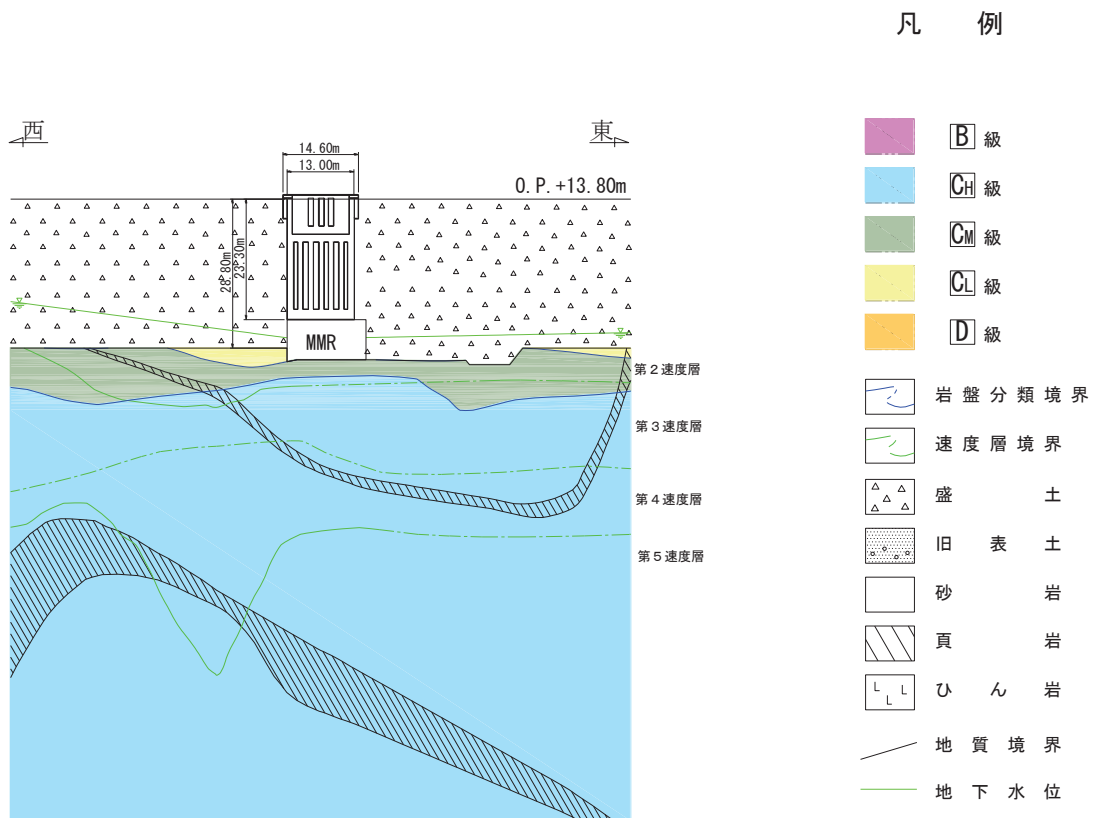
(3) 第 3 号機補機冷却海水系放水ピットの解析断面図 (EW 断面) (3/3)
